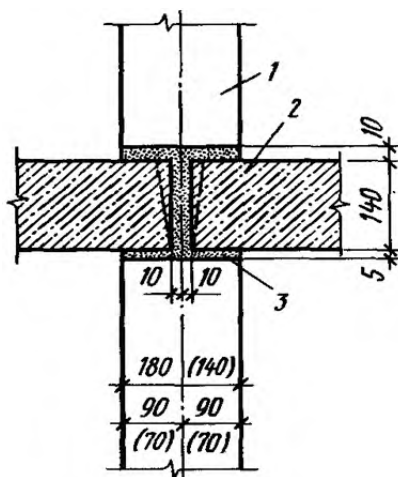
Конструкция горизонтального платформенного стыка панелей внутренних поперечных несущих стен:
